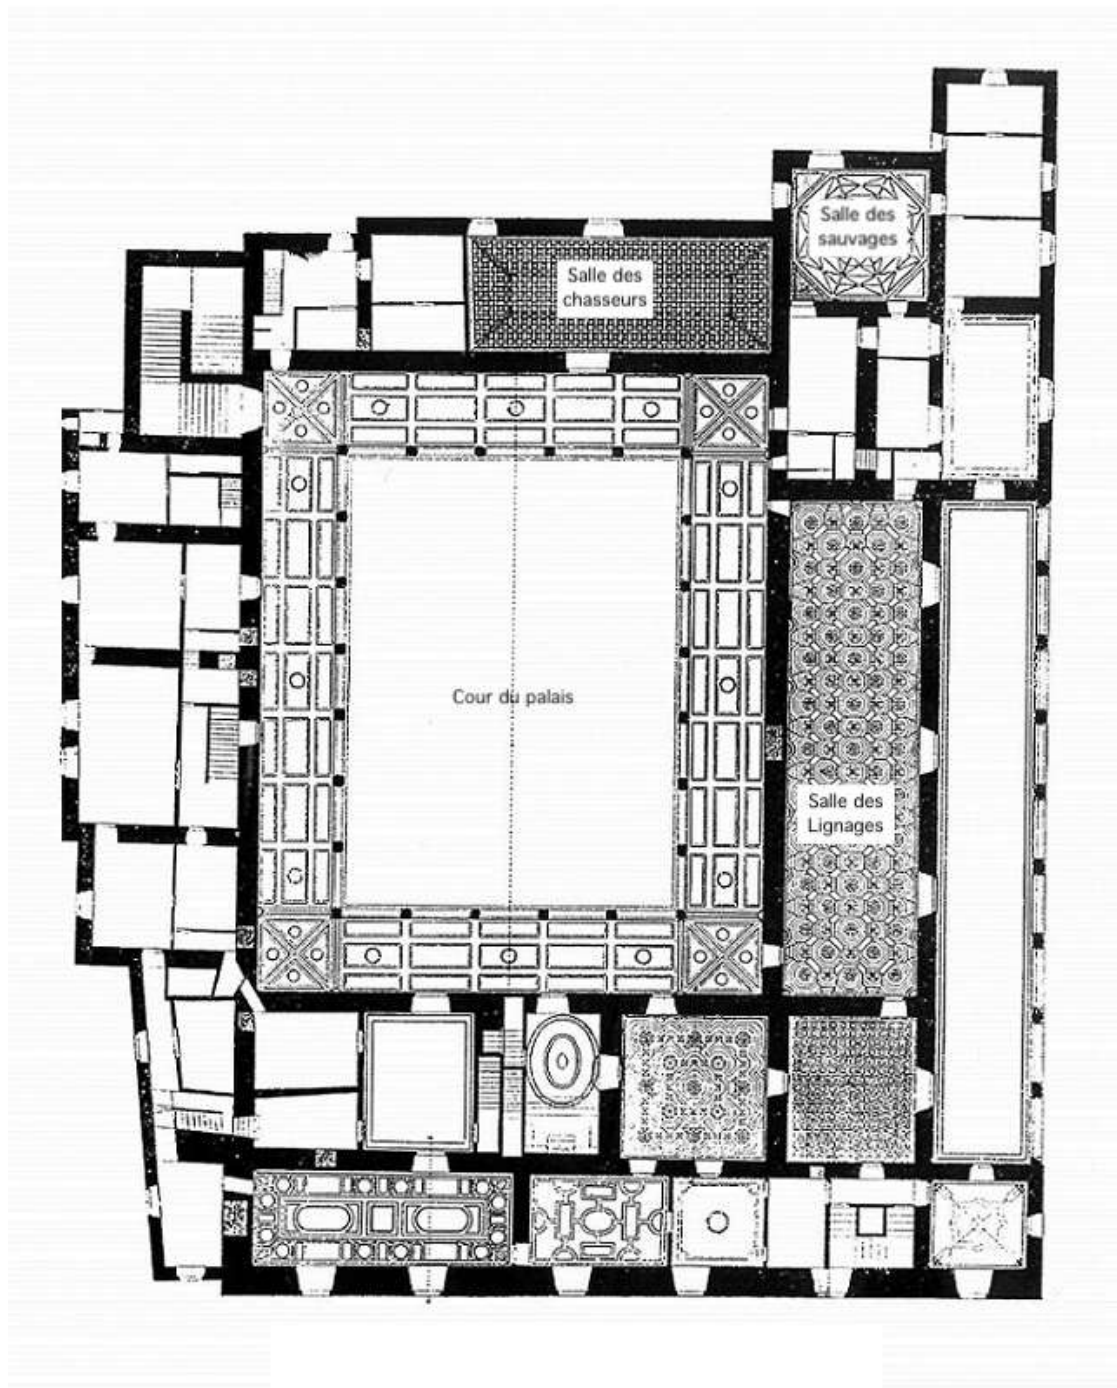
Plan du palais, et indication des plafonds au premier étage. Plan extrait de José Amador de los Ríos et alii, Palacio Ducal del Infantado en Guadalajara, Madrid, Real Academia de Bellas Artes de San Fernando, 1877.
